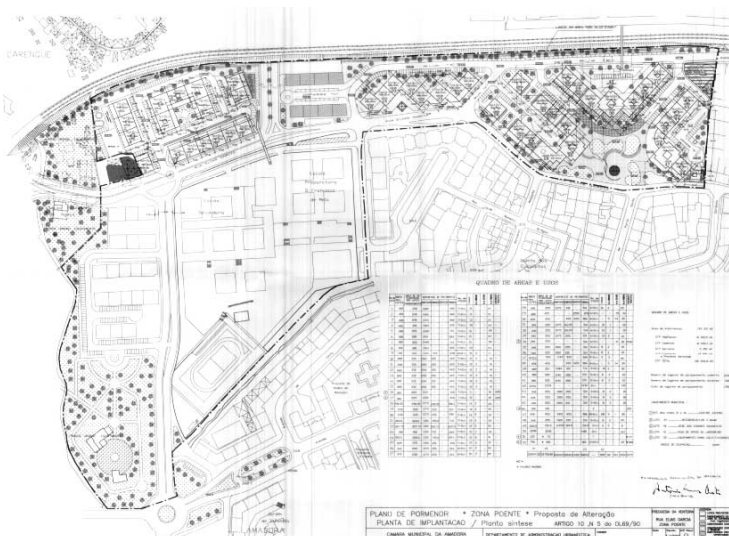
Plano de Pormenor da Rua Elias Garcia e da Zona Poente, C.M. da Amadora
